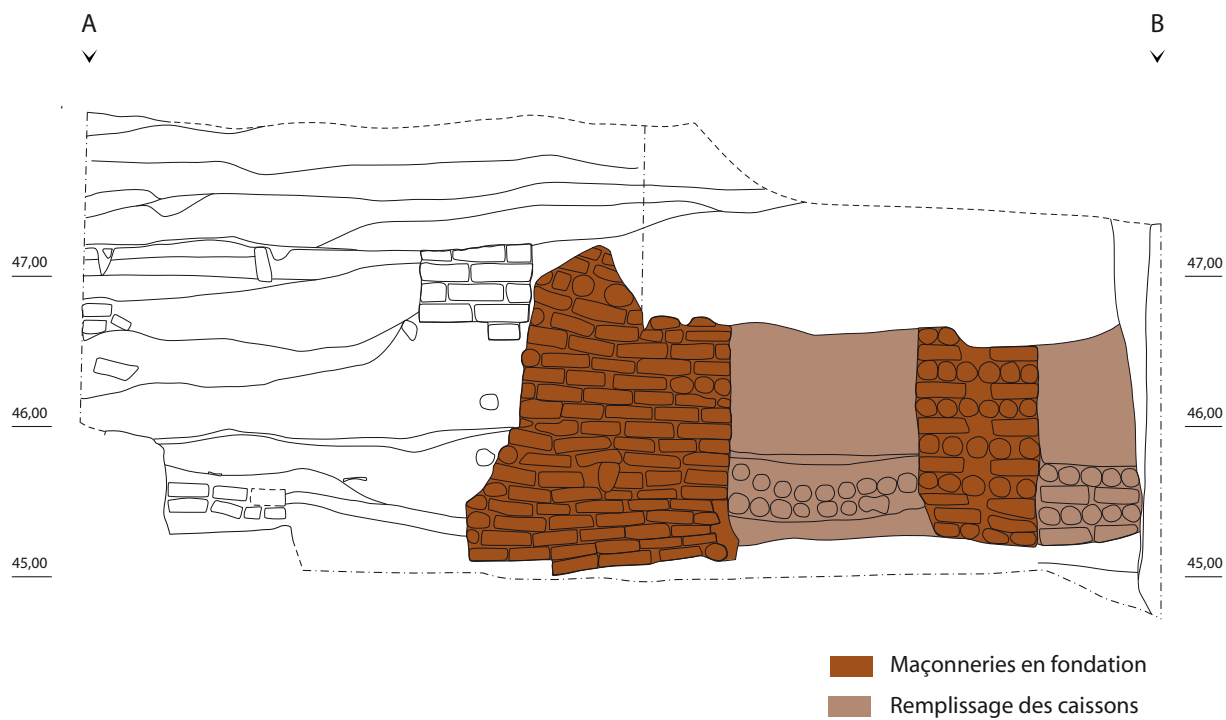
Coupe schématique des fondations de l'extrémité de l'aile nord
